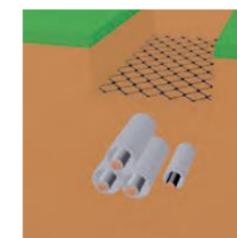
Principe d'enfouissement et coupe d'un câble de raccordement souterrain (source : RTE)
